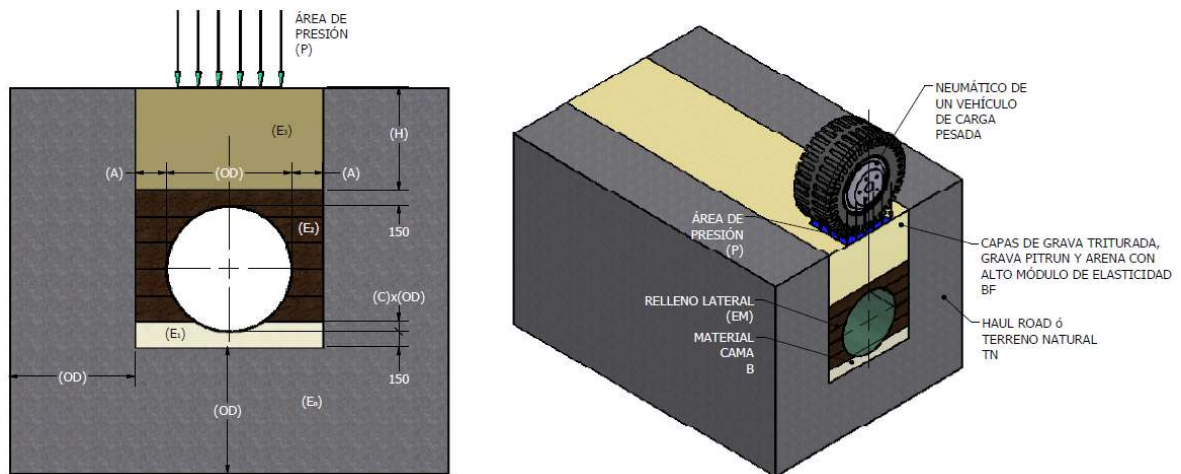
Esquema parametrizado de sección de instalación de tubería en zanja, (dimensiones en mm).
